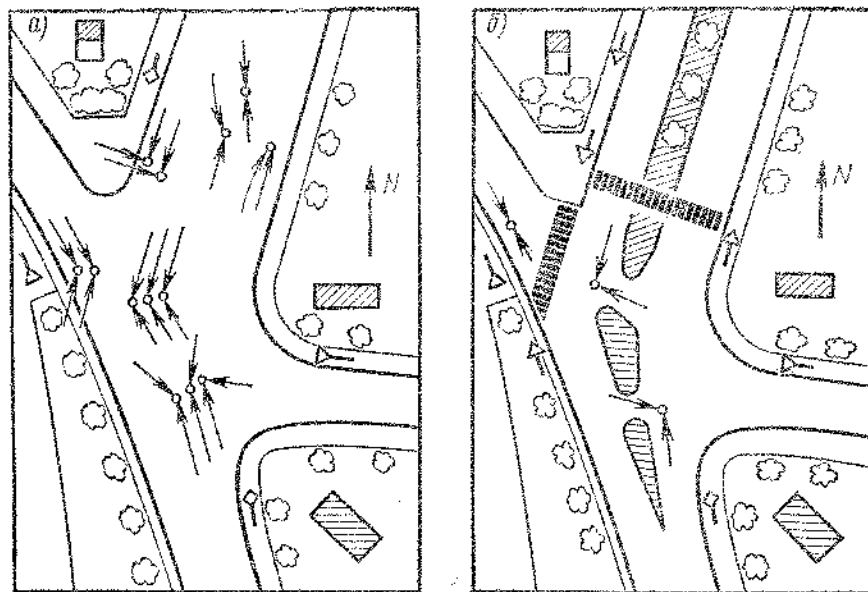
Пример использования плана дорожно-транспортных происшествий для реконструкции перекрестка:
